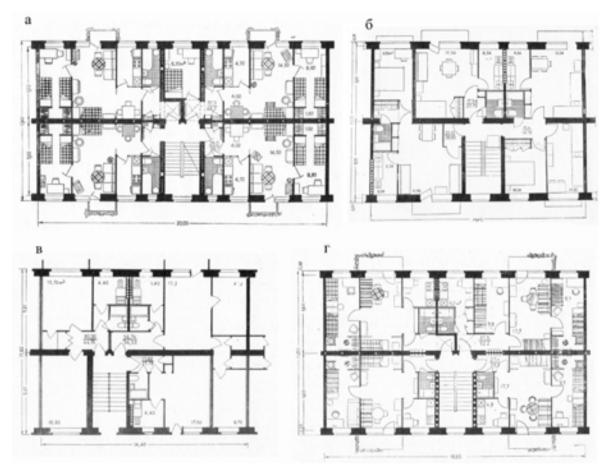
9-й квартал [10]: а – секция дома № 2; б – секция дома № 4; в – секция дома № 7; г – секция дома № 11
